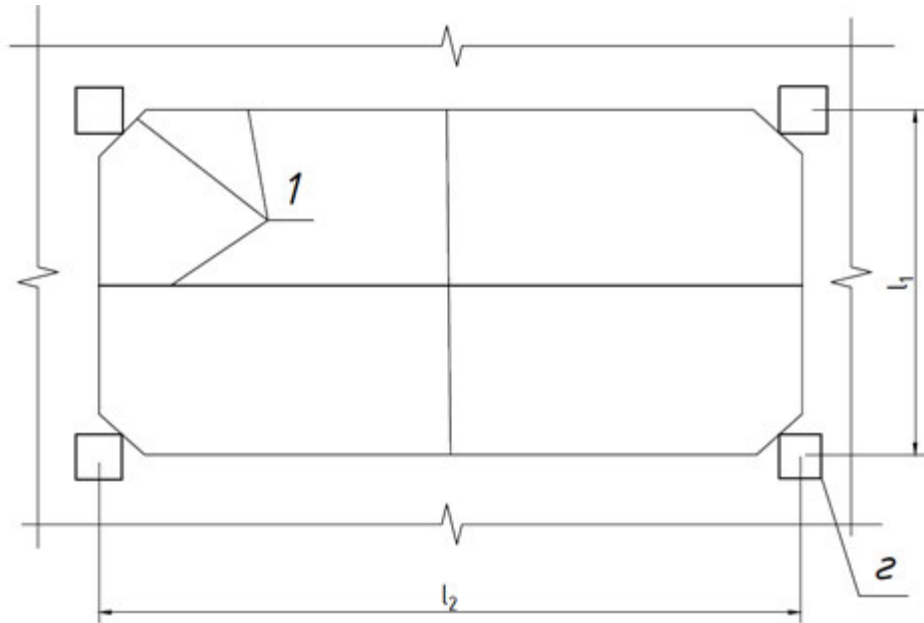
Схема пластичних ліній зламу (1) плити з зосередженими опорами (2)
